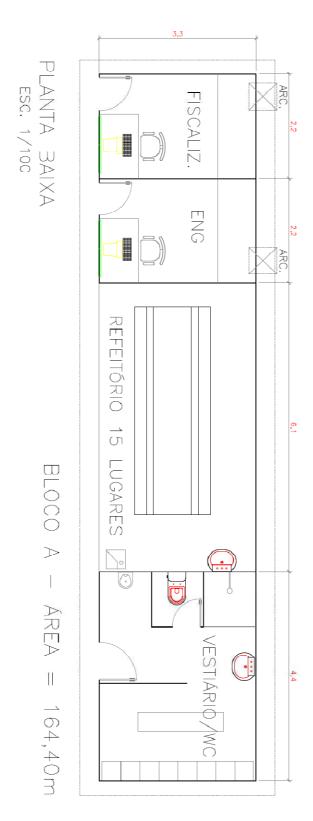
Planta baixa do primeiro prédio do barração de 15 pessoas.
